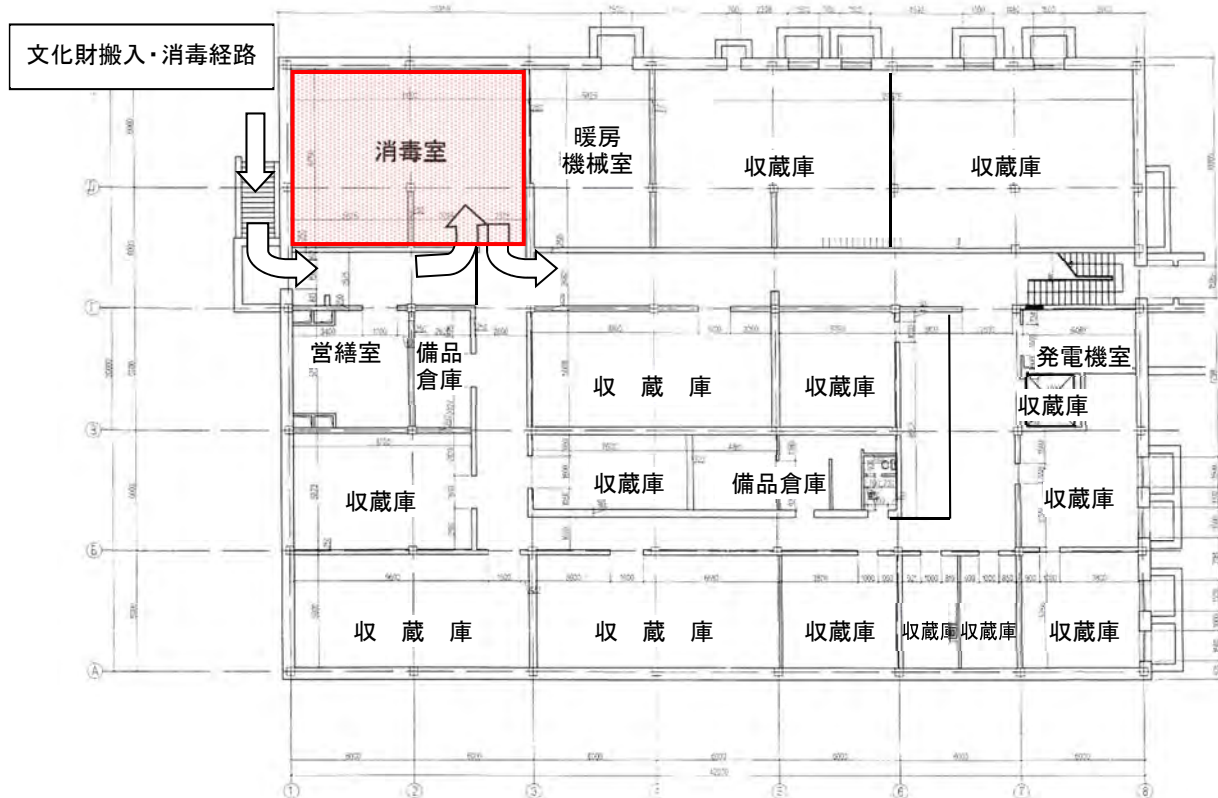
自動調湿窒素発生装置の設置場所と文化財搬入経路：地下 1 階平面図
